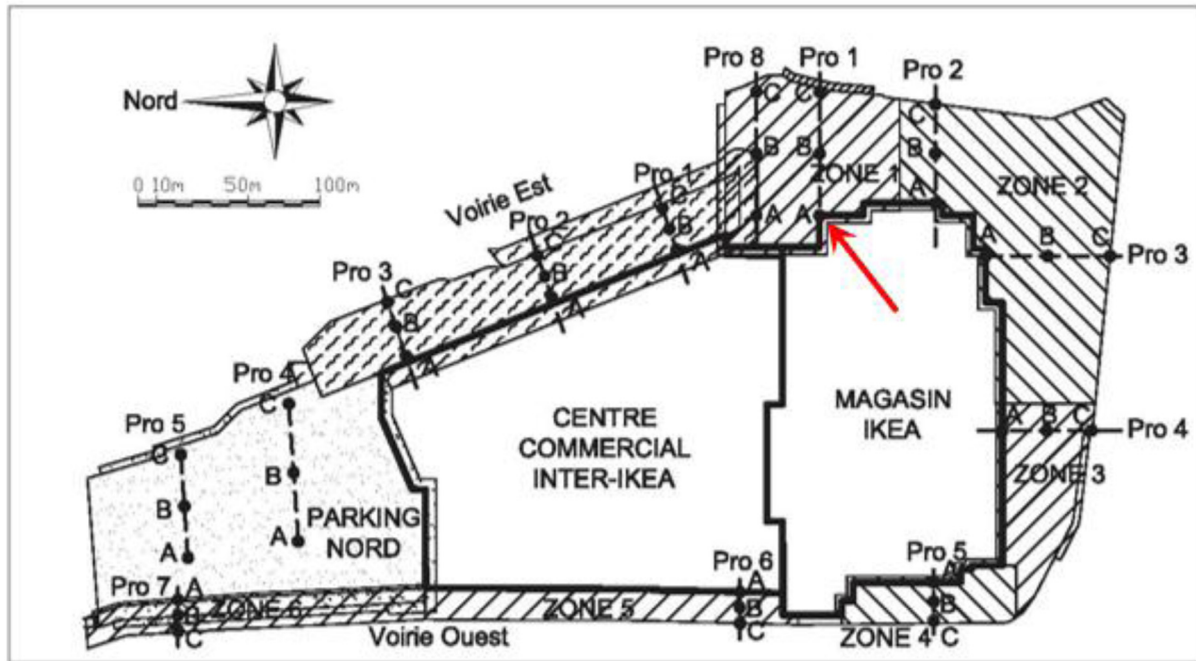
Plan du projet, avec parkings, zones de calcul et points d'instrumentation.
